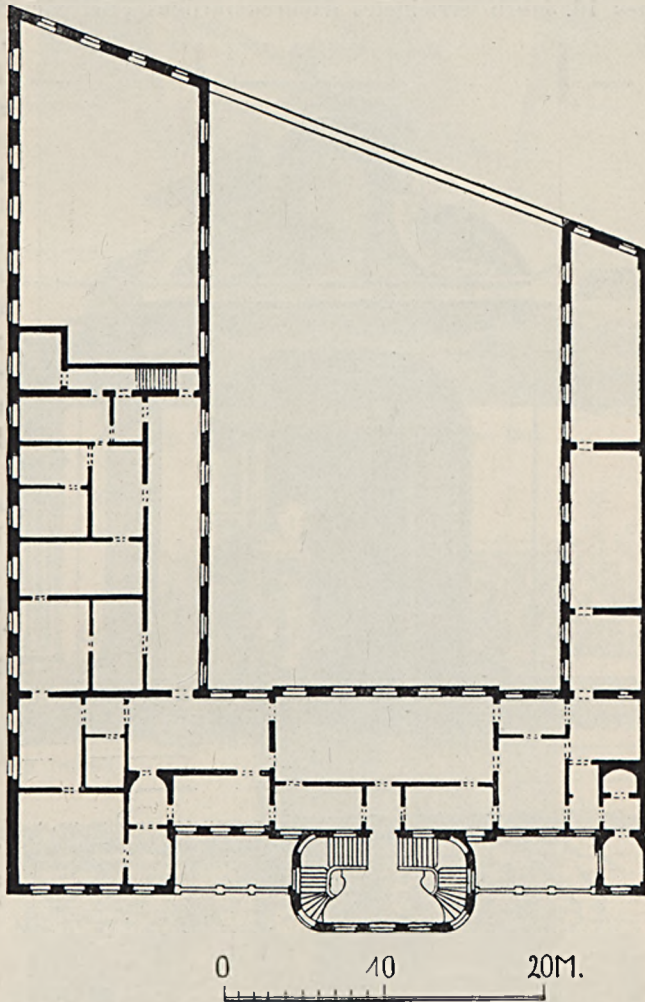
Friedrichstrasse Nr. 52, Grundriss des ersten Obergeschosses.
